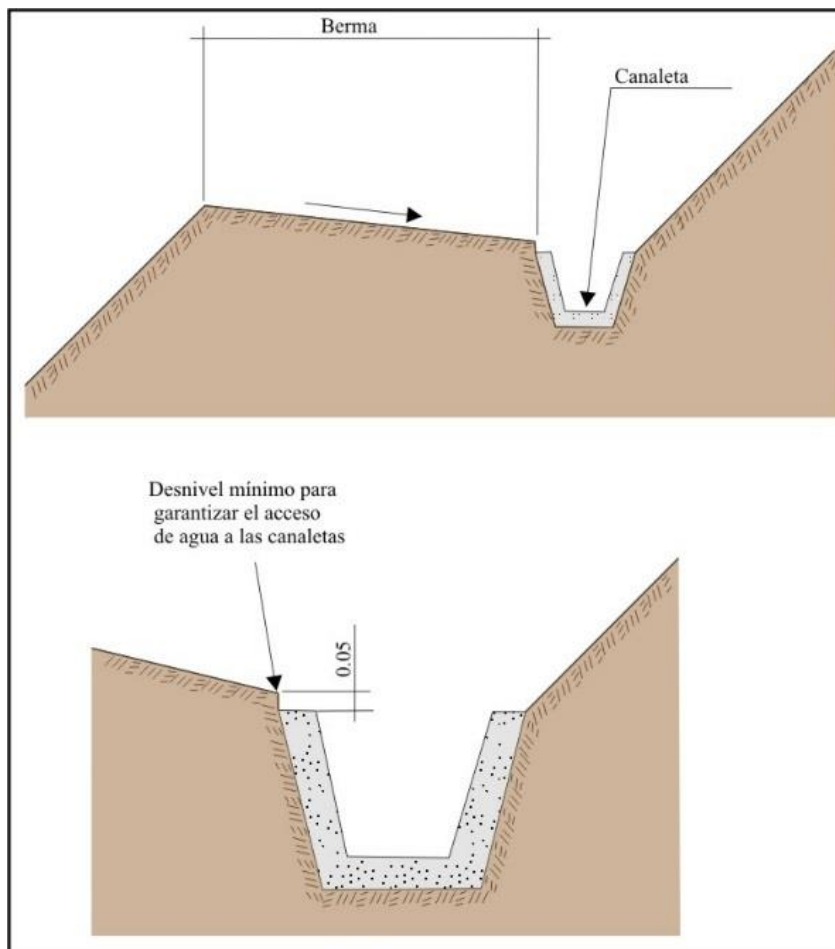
Detalle de una canaleta de drenaje superficial (tomado de Ingemmet, 2000)
